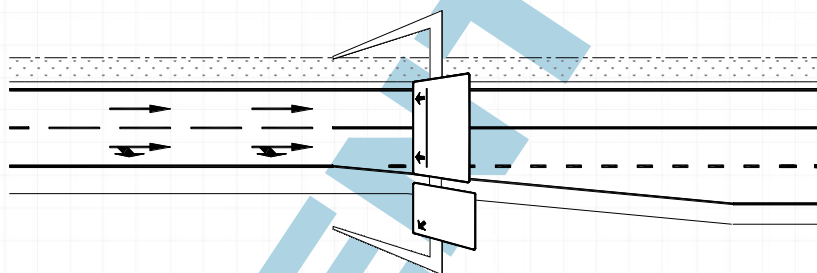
14 - Colocação longitudinal do conjunto E1+E2 em intersecções desniveladas
